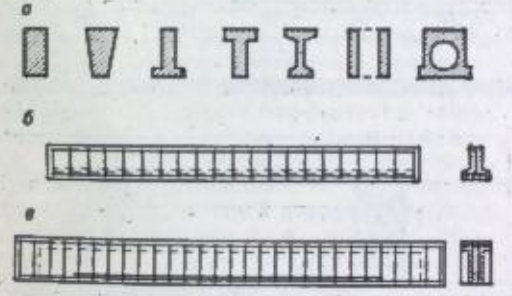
Сборные балки: а — сечения балок; б — армирование тавровых балок с полкой книзу; в — то же с полкой поверху плоскими сварными каркасами.
